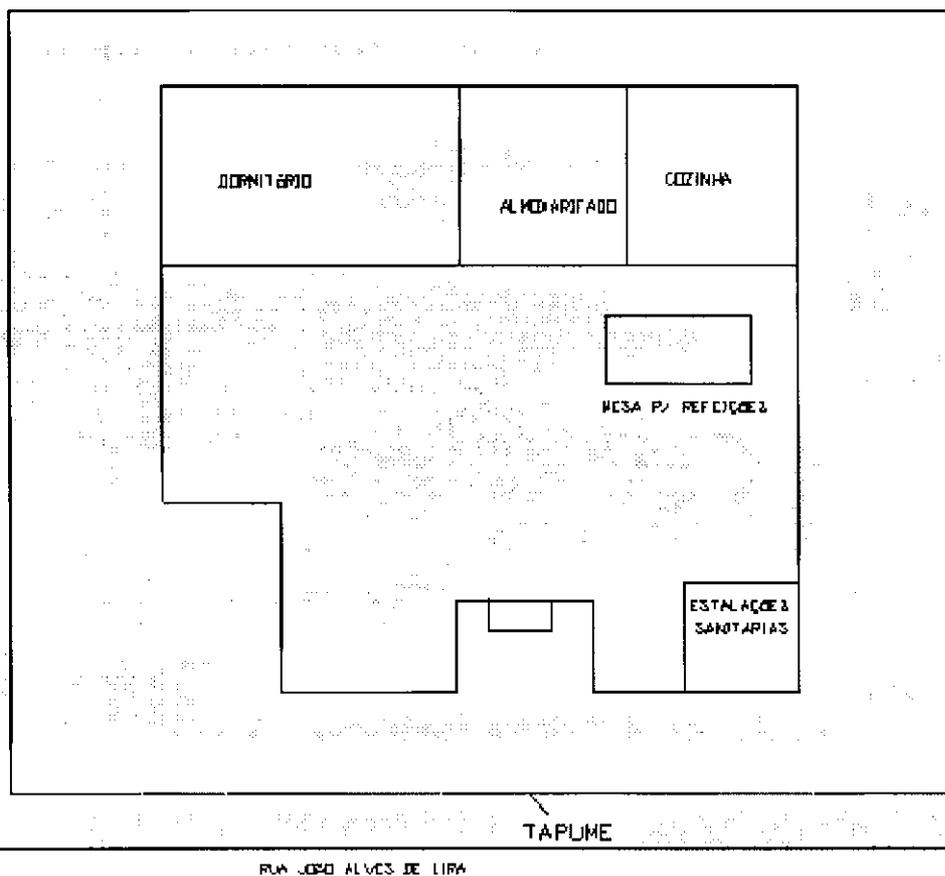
Esboço do canteiro de obras - 1ª Laje
